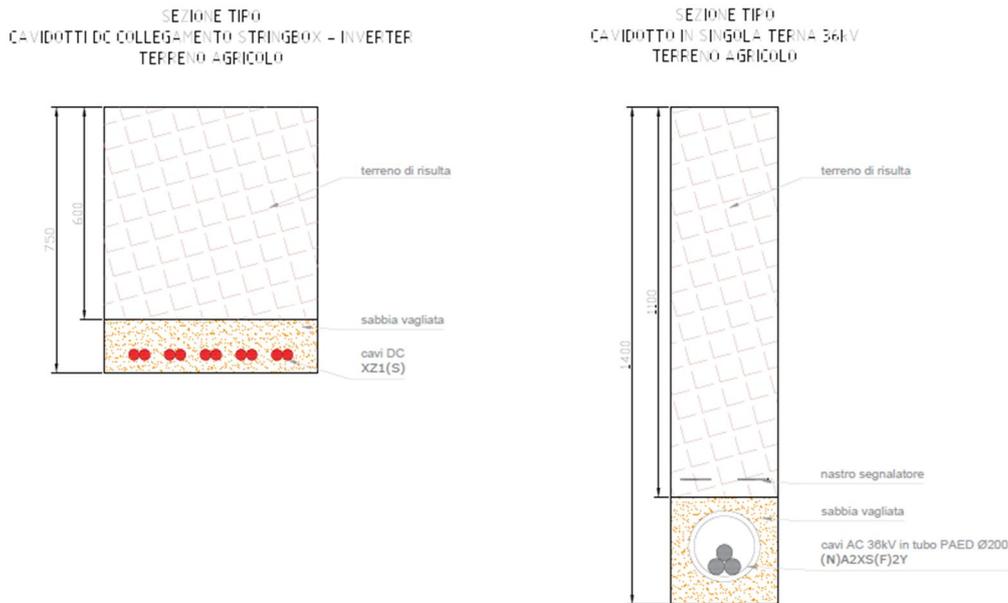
Particolare di posa dei cavi DC e dei cavi a 36kV interni al campo
